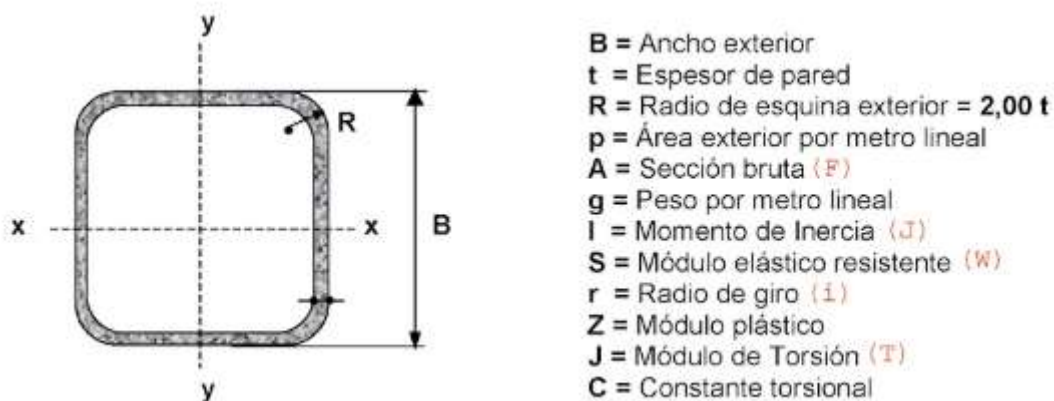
Dimensiones de la sección de un perfil metálico cuadrado.
